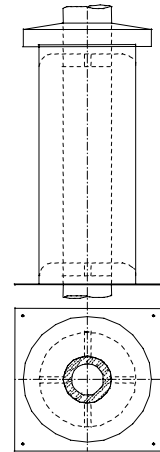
Aufbau Stulprohr mit integrierter Ablufführung
